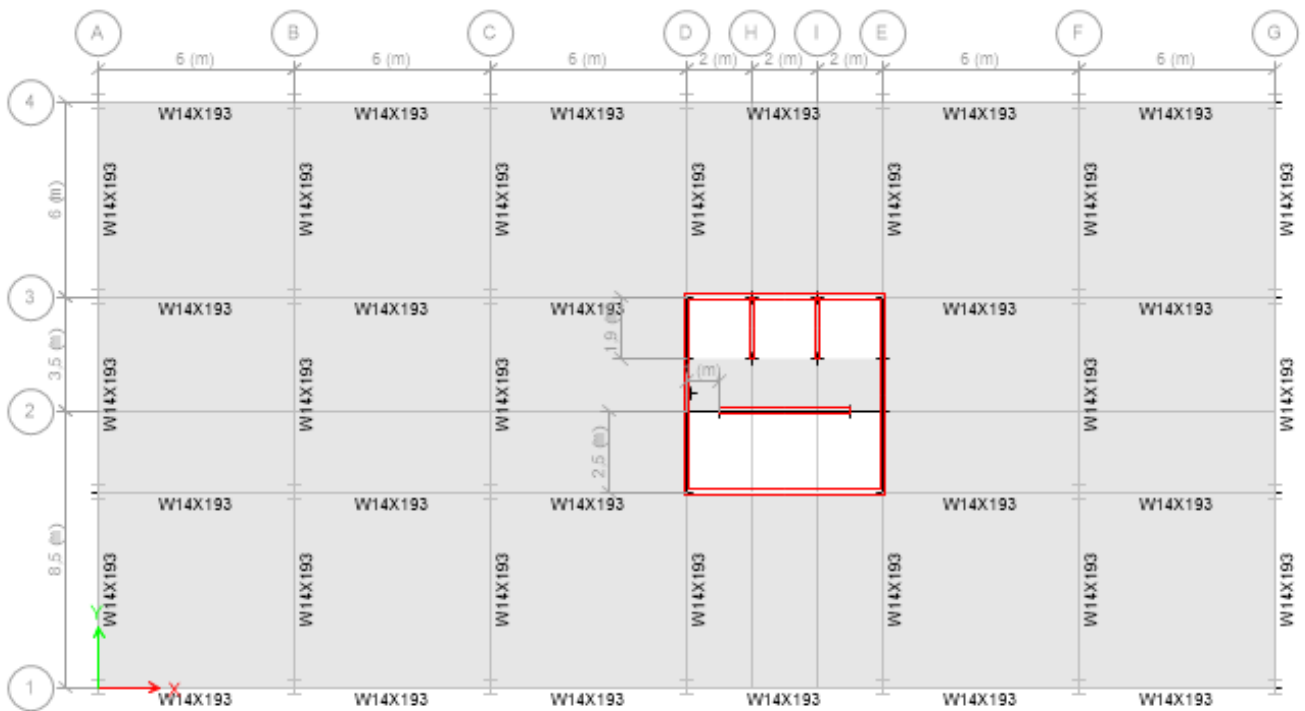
8: Vista en planta de las vigas correspondiente a los pisos 6-12, edificio tipo A.
